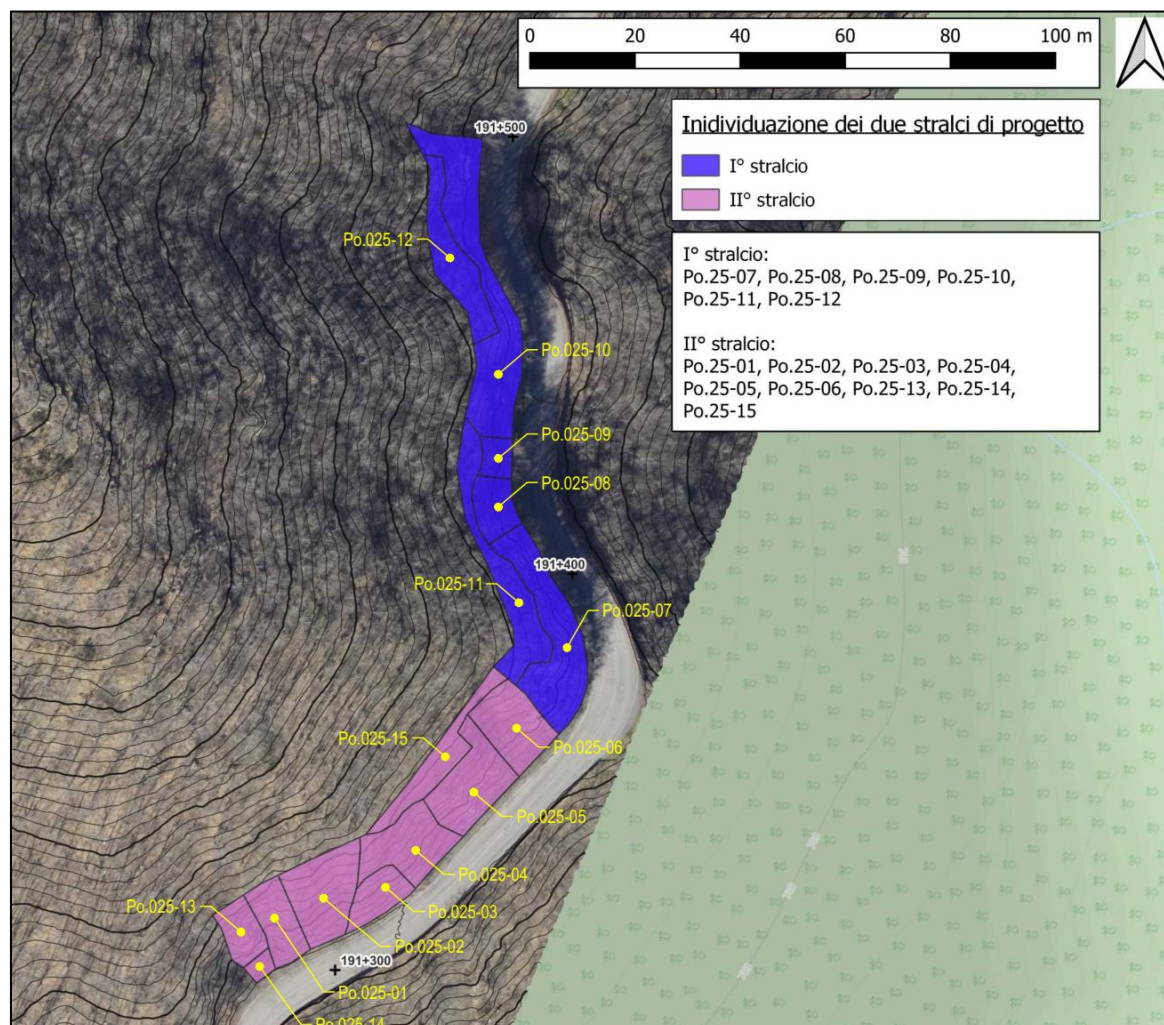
Individuazione in pianta dei due stralci in cui si sono suddivisi gli interventi di progetto.
